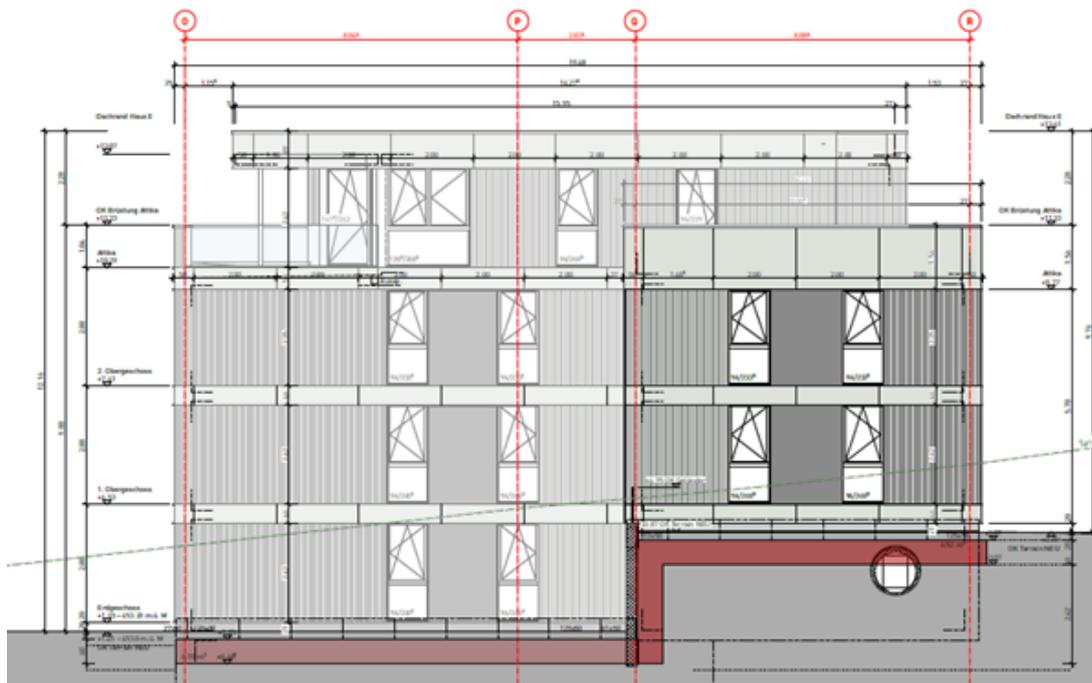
Grundstück mit mittlerer Neigung (5–9 Grad), Gebäude mit Wohnfläche im Untergeschoss
